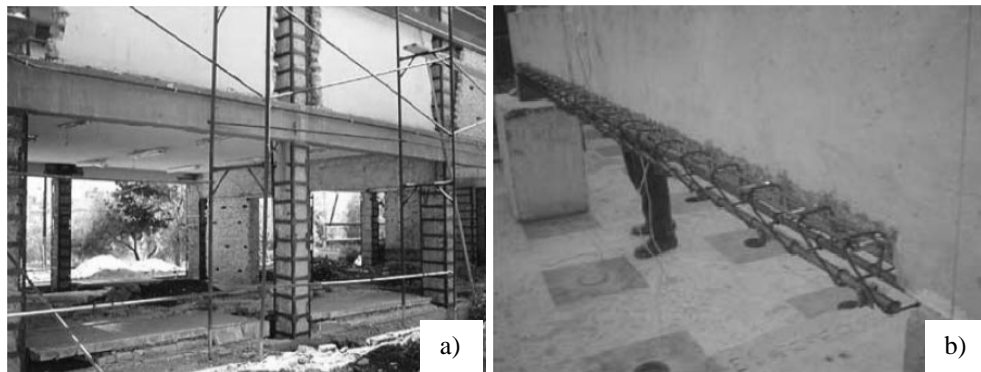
a) Reforço de pilares com encamisamento da secção (Fardis, 2009); b) Pormenor da intervenção de reforço de uma viga com a técnica do encamisamento da secção (Shehata *et al.*, 2009).
